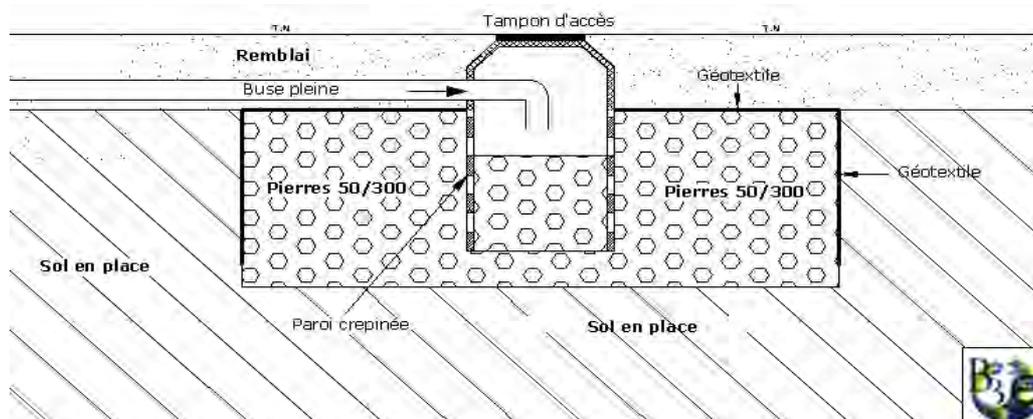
Coupe schématique d'un puits d'infiltration (source : B3E)
